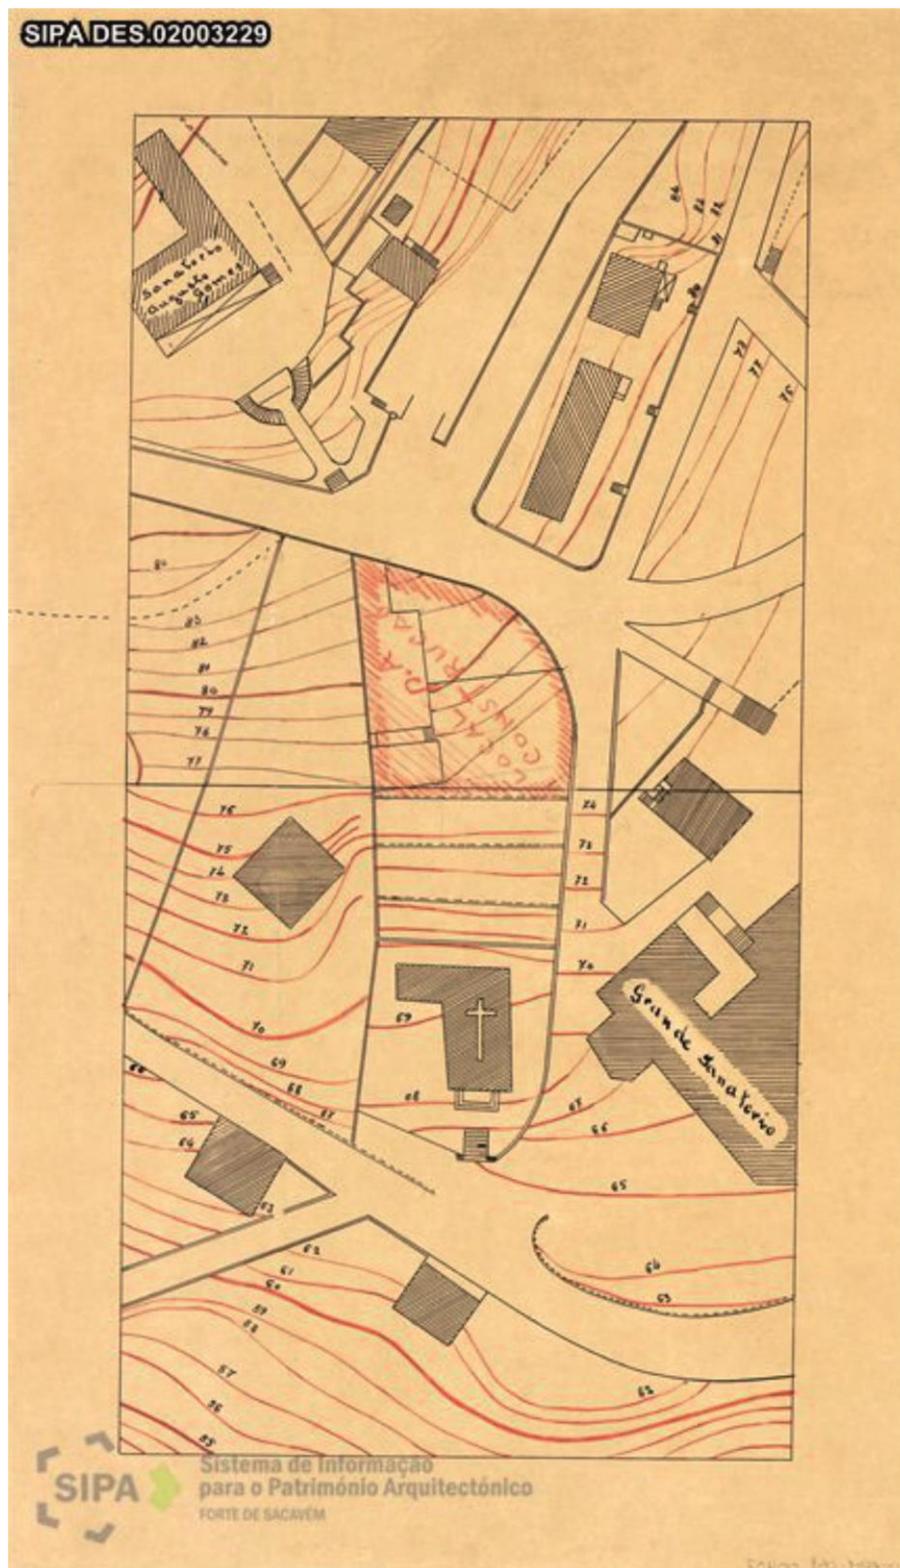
Planta de Implantação – projeto de Pardal Monteiro (fonte: SIPA)
